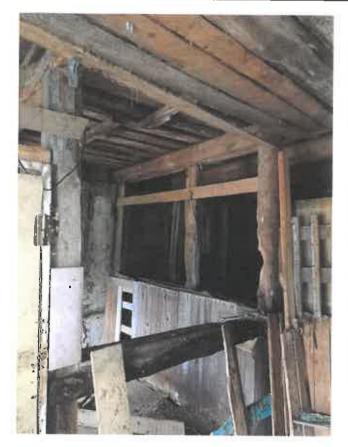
Ч.п.6 (конюшня) пом.1-Н
